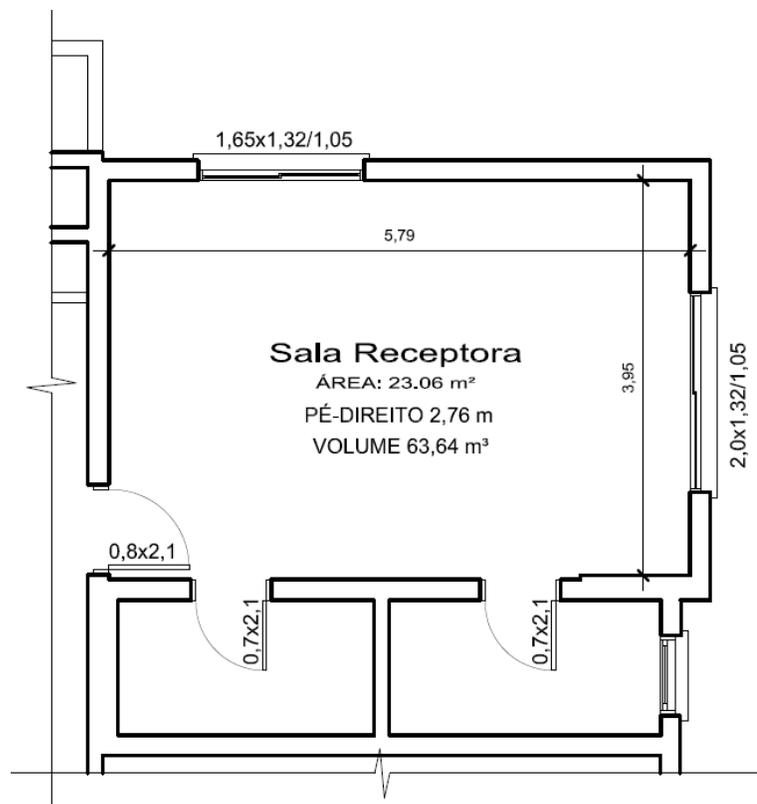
Planta baixa da sala receptora, tipologia de laje: Laje maciça.
